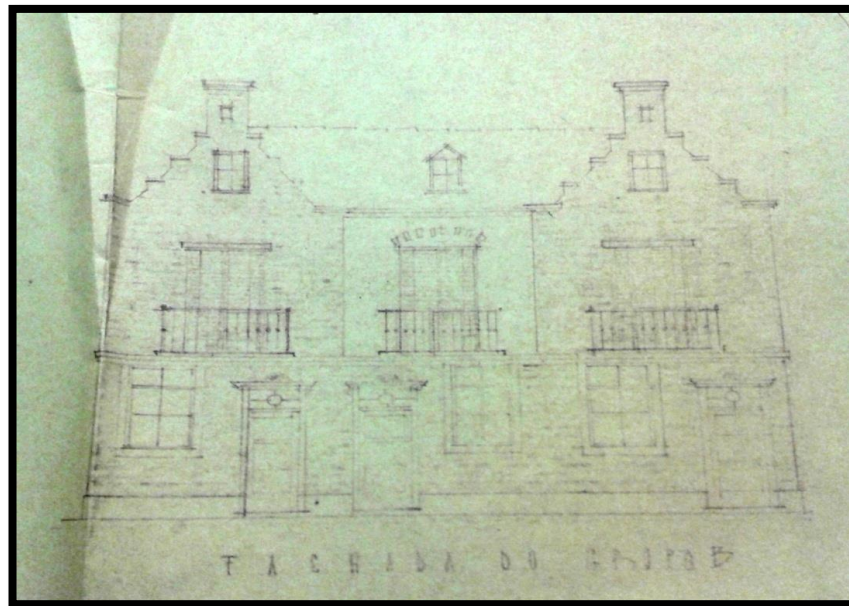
Projetos de fachadas não realizados. Fonte: 1982-0.022.567-4 – Planta 21.
